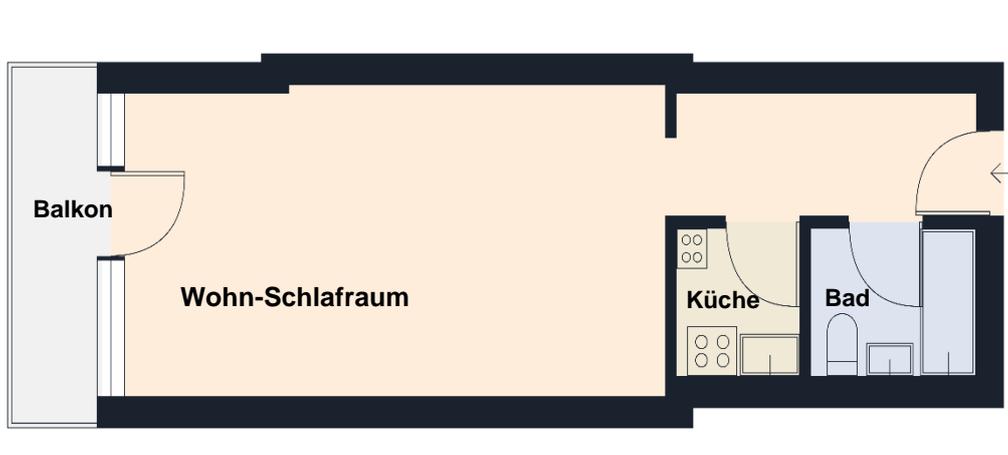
Grundriss Wohnung Nr. 33 (Aufmaß vor Ort)
